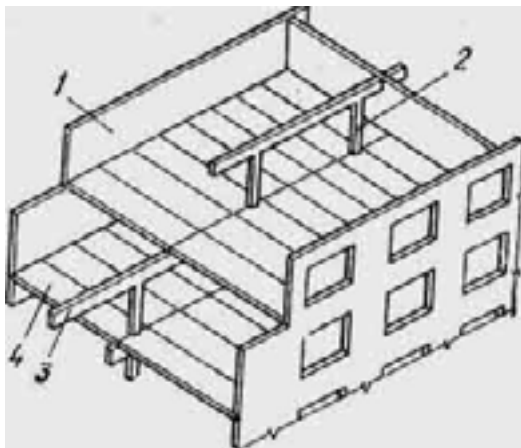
Элементы, обеспечивающие пространственную жесткость зданий с неполным каркасом: 1-несущая стена; 2-внутренняя колонна; 3- ригель; 4 – перекрытие
